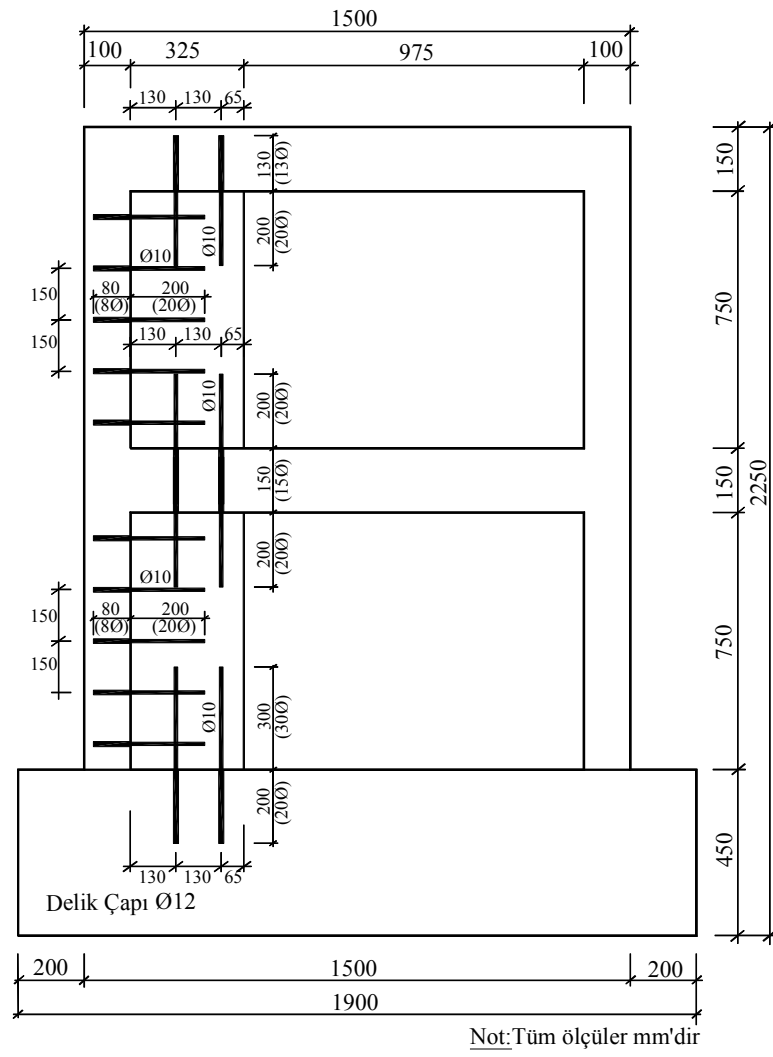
Deney Elemanı-3'ün donatı detayı
